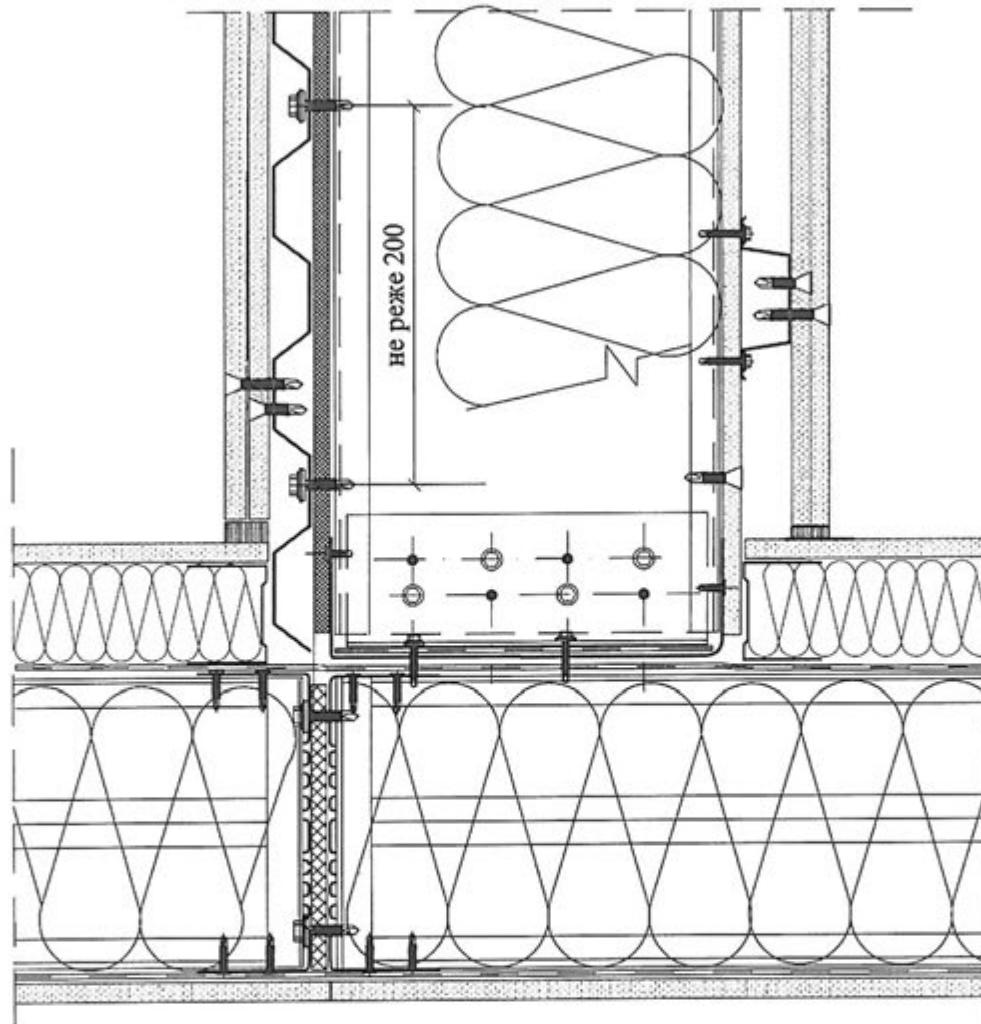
Узел крепления и примыкания конструкции междуэтажного перекрытия к наружной несущей стене.
